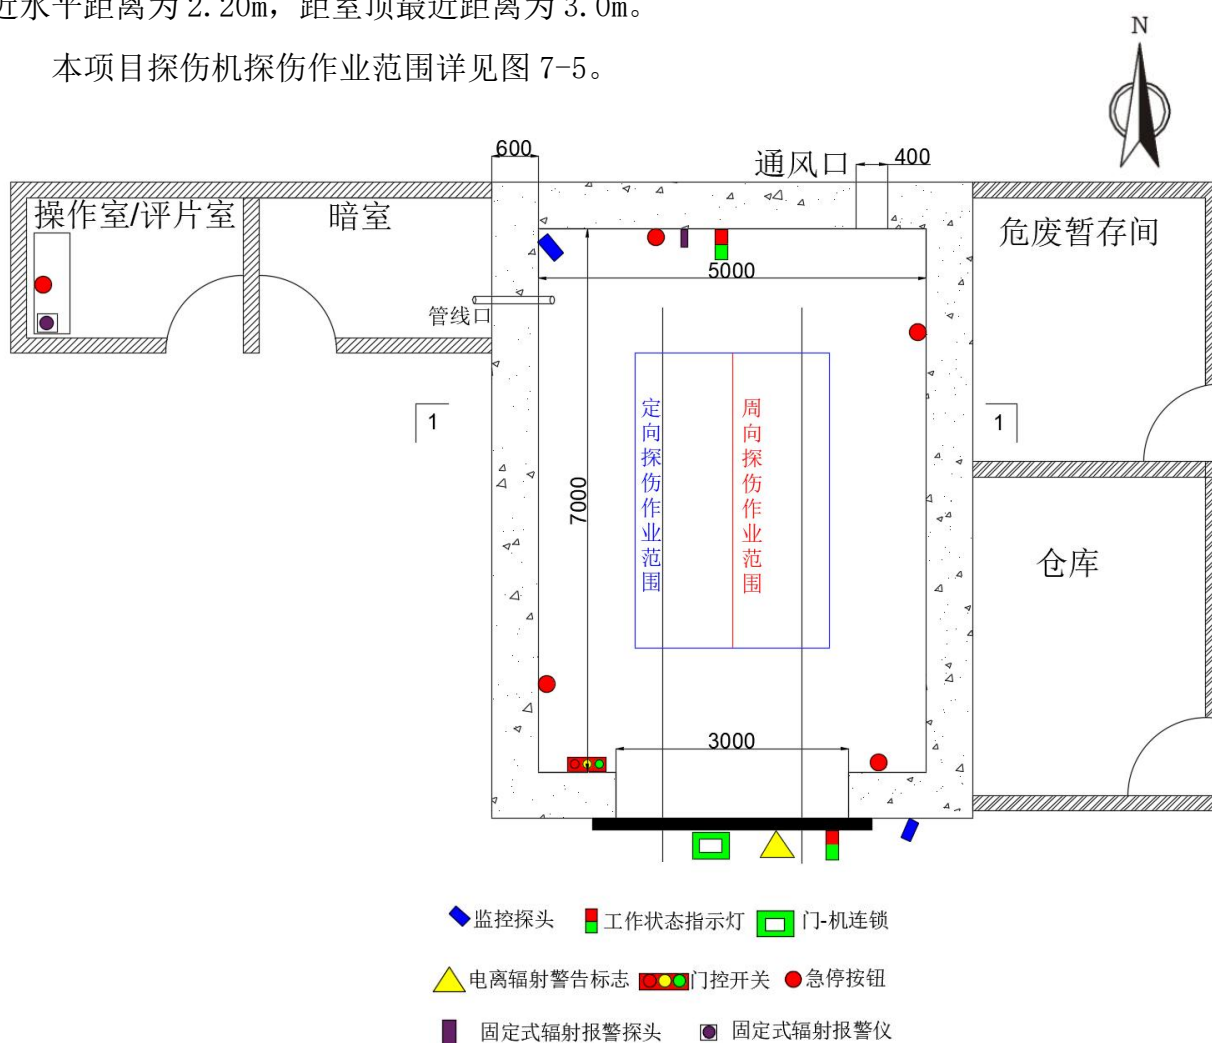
（a） X 射线探伤机在探伤室内探伤作业范围示意图（平面图，单位：mm）
